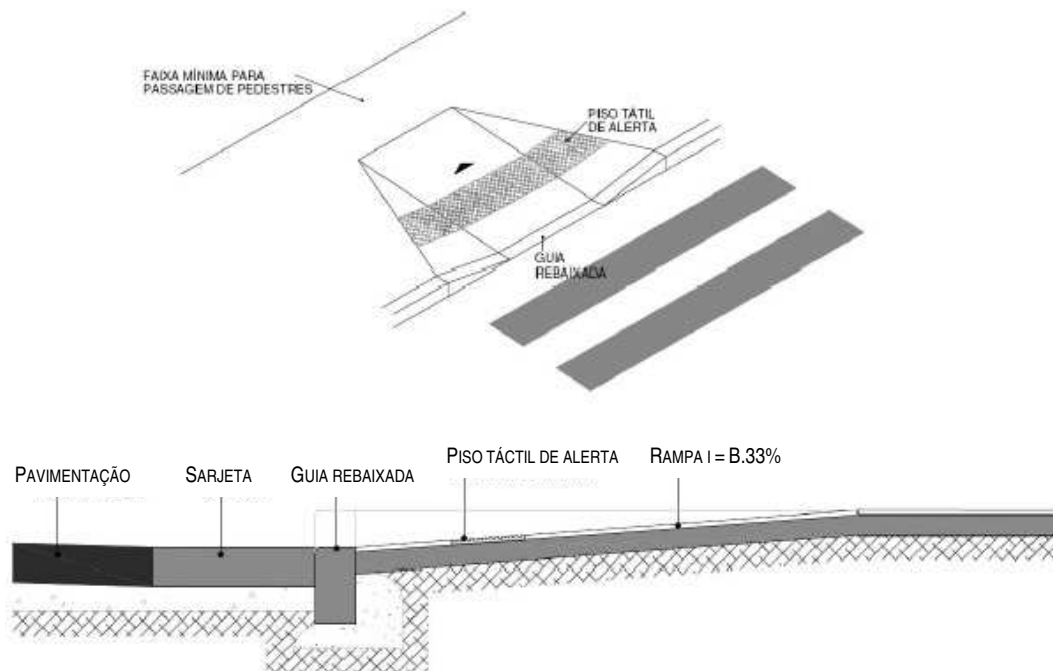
Perspectiva e corte longitudinal de rebaixamento de guia com aplicação de piso tátil de alerta
